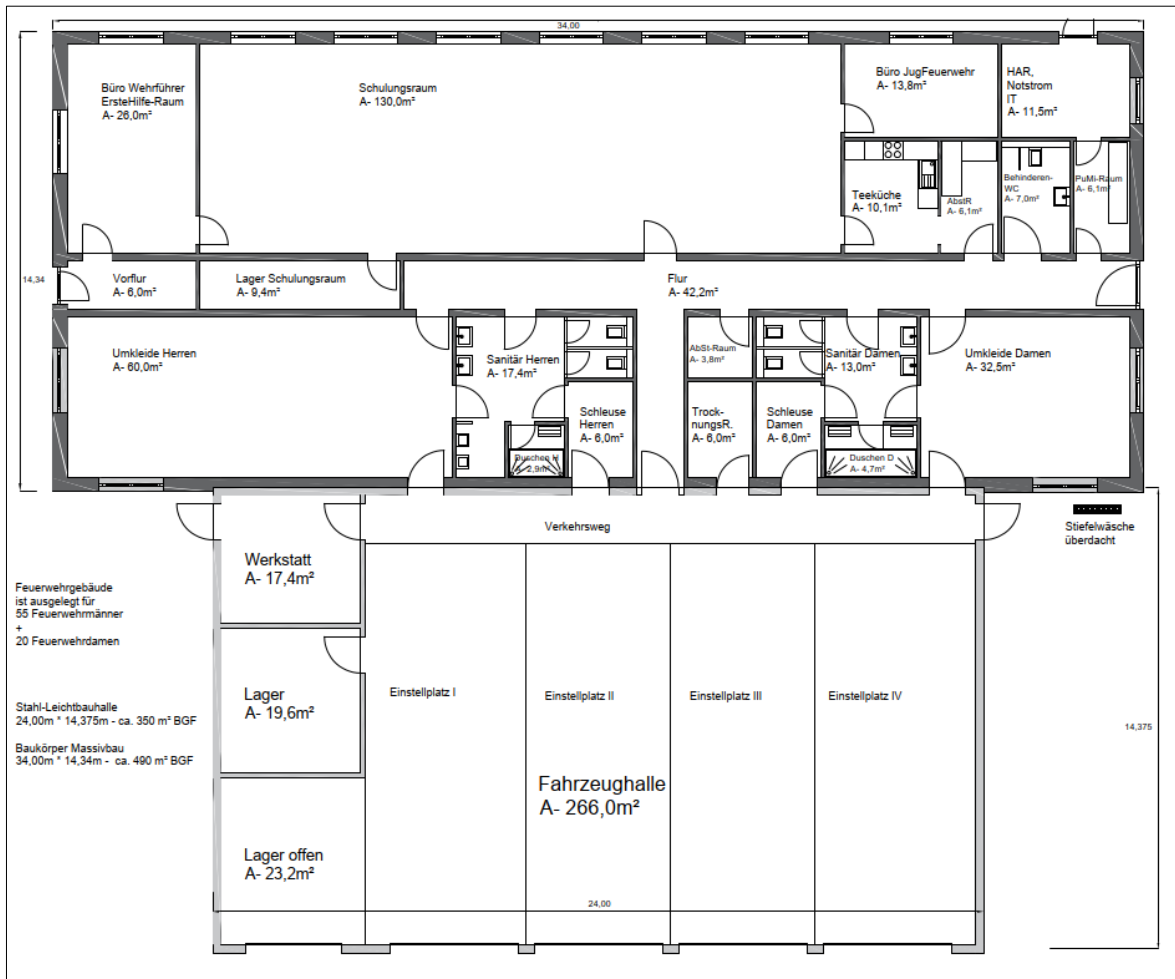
Mustergerätehaus Grundriss EG, Stadt Fehmarn
